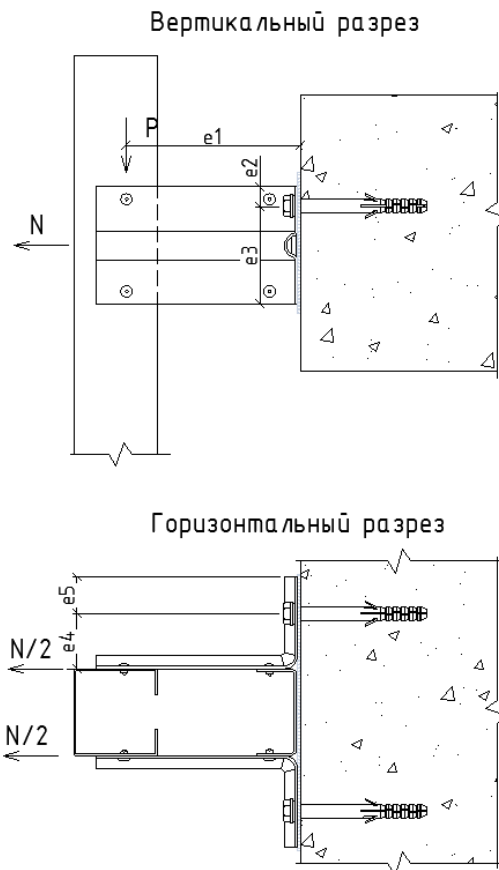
Расчётная схема кронштейна КНс-28/1 для проверки анкерного элемента на вырыв
